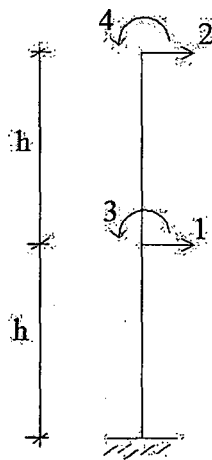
Modelo estructural y gdl's del muro patrón.
